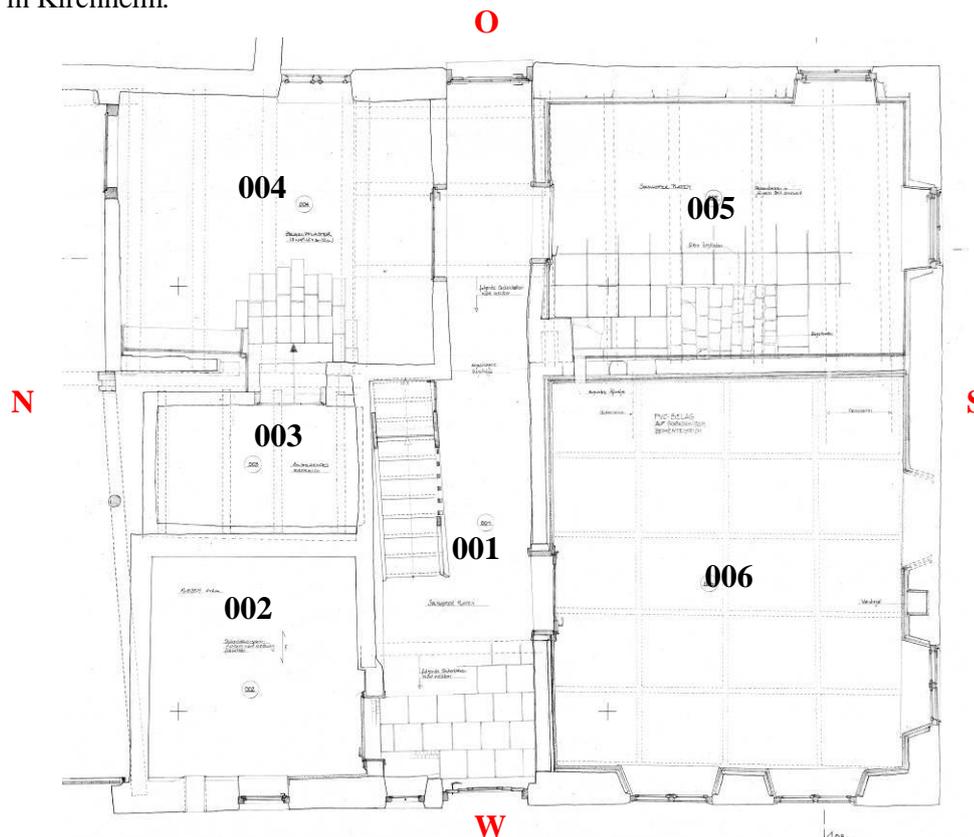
Ausschnitt aus dem Grundriss des Erdgeschoss (Wohnteil)
